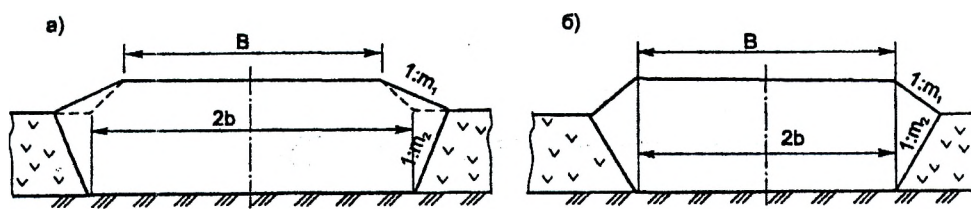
Схемы земляного полотна с удалением слабых грунтов в основании: а – для усовершенствованных покрытий; б – для переходных и низших покрытий
